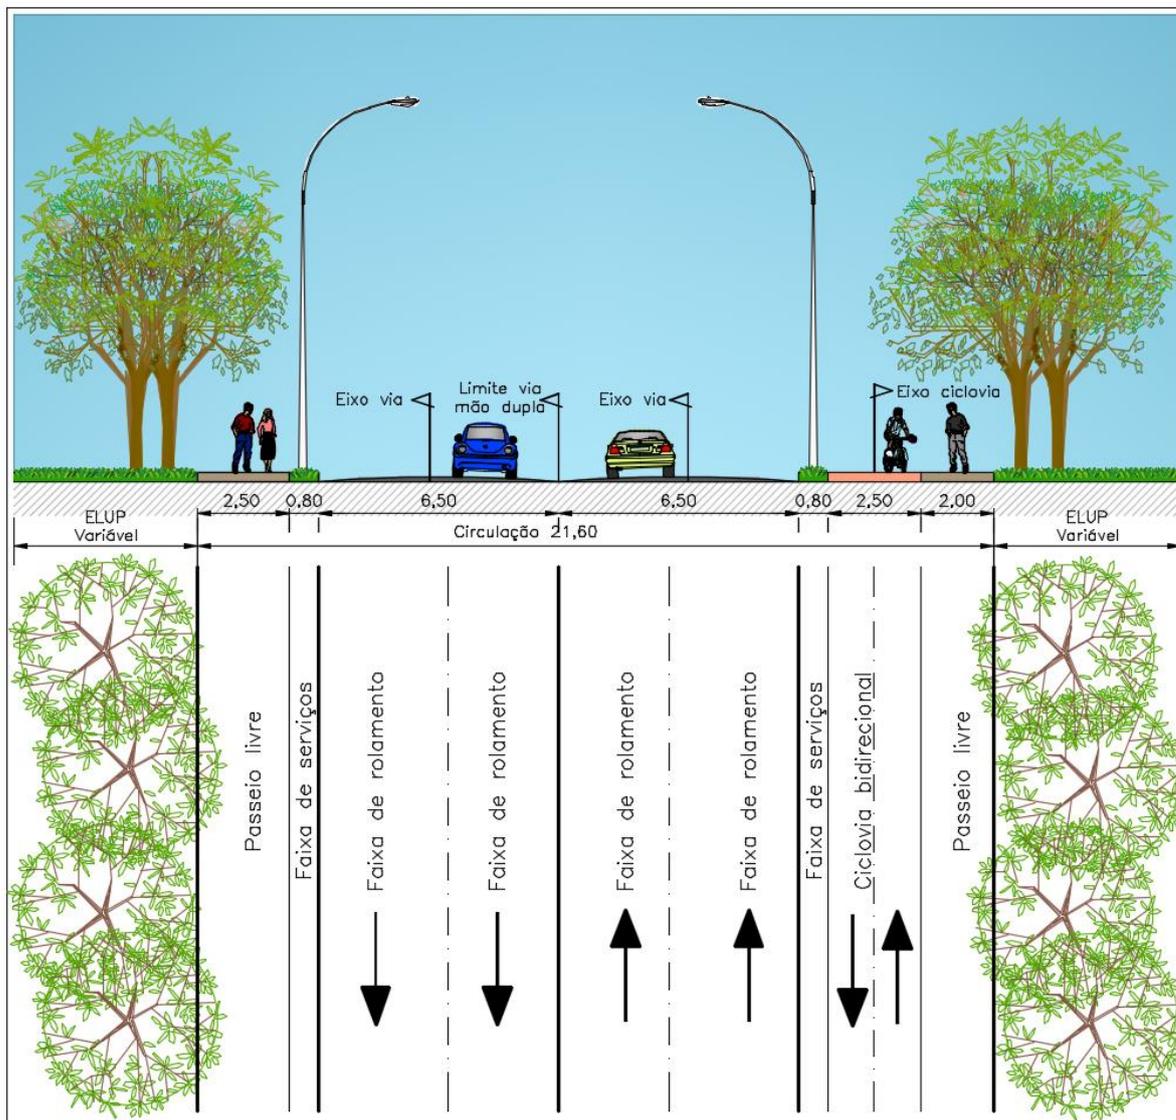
Perfil 06 - Via de Circulação (entre ELUPs)
